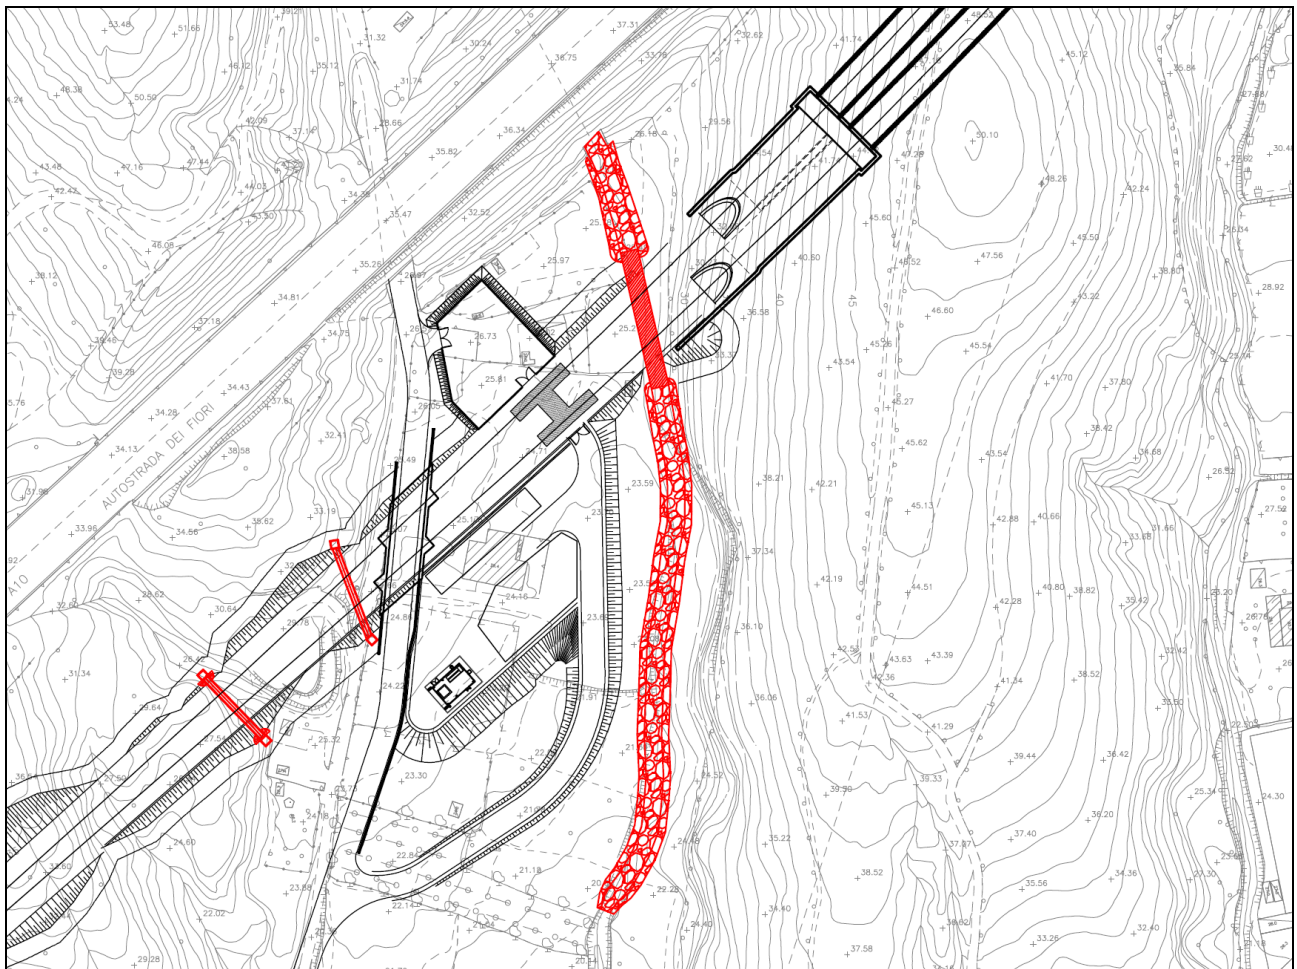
Pianta della sistemazione idraulica del Rio Fasceo
